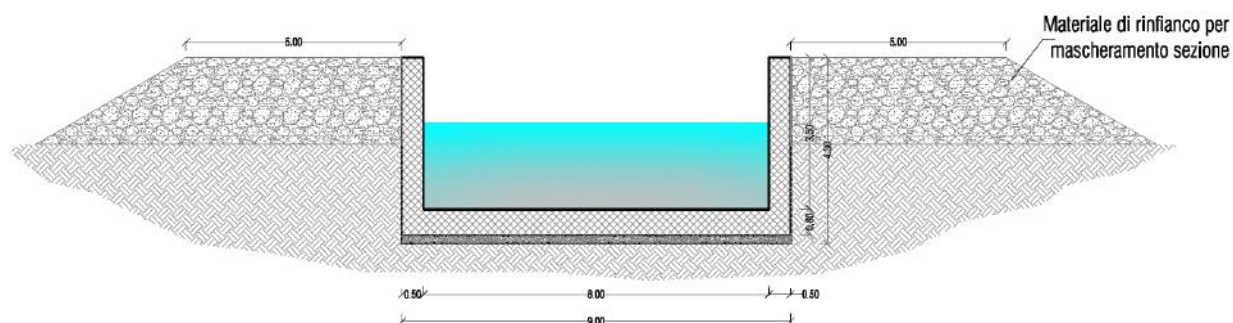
Sezione lama Scorbeto tratto artificiale
